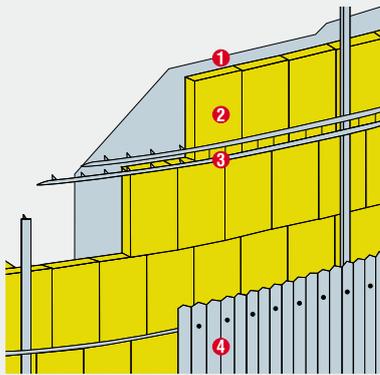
1. Стенка резервуара, 2. Плиты TECHROCK 60, 80 (укладываются на «вжим», без шпилек), 3. Опорная конструкция кожуха – вертикальный деформационный шов, 4. Защитный кожух из профилированного листа.
